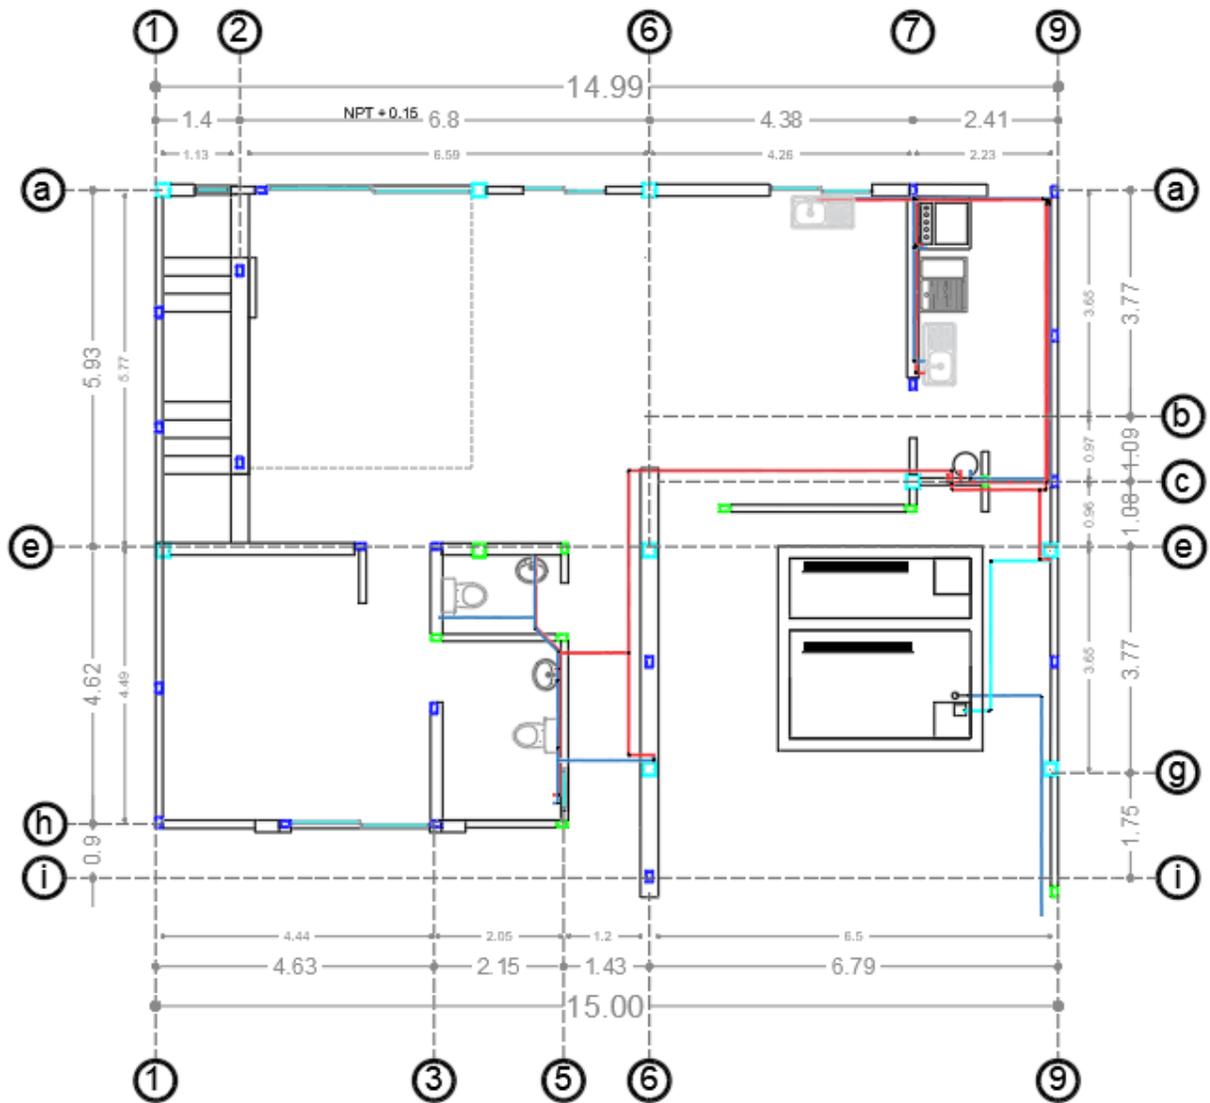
Plano hidráulico planta baja (Muciño, 2022)
